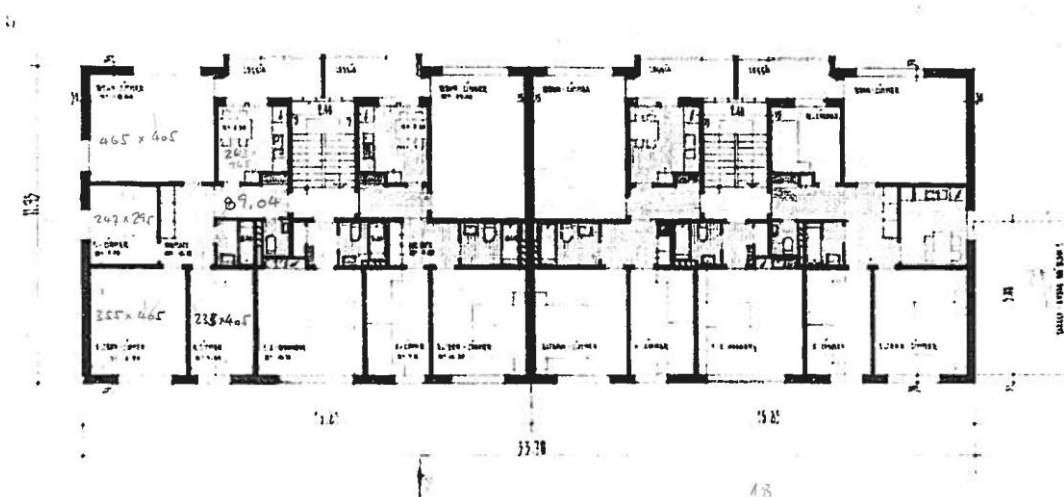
Grundriss Standardgeschoss (1.-4.OG)
